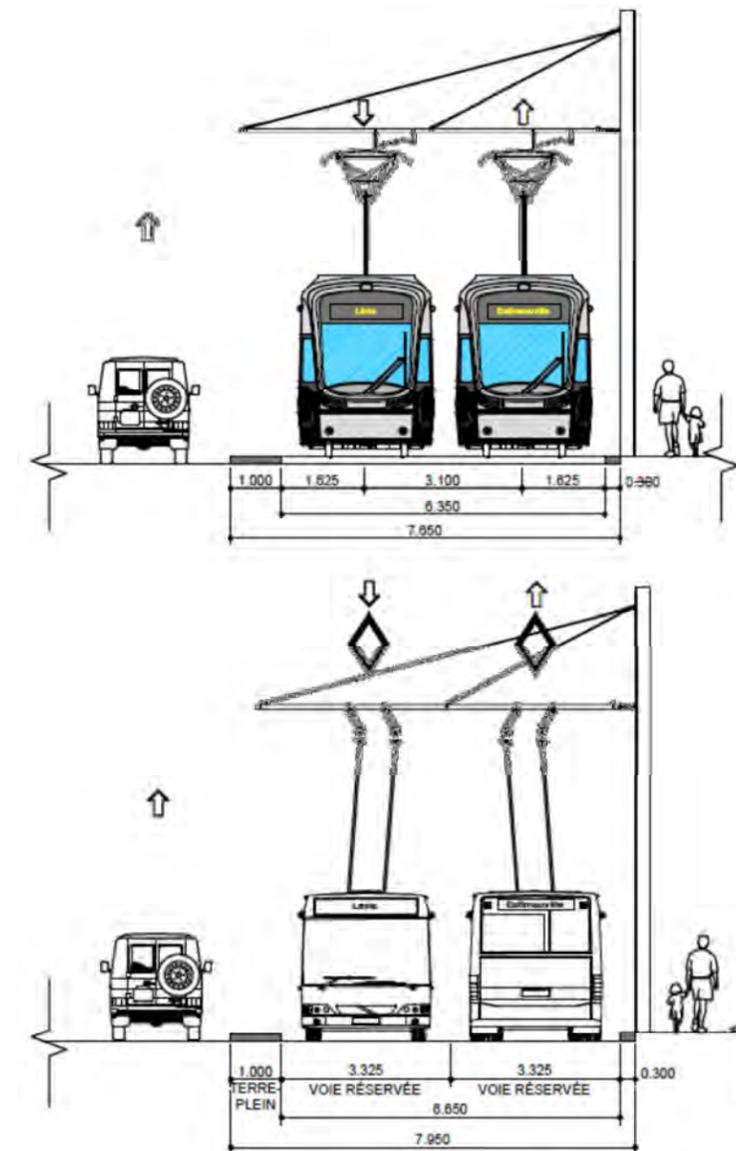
Coupe type 12 de 15 - SRB - Site espace restreint - Insertion latérale
